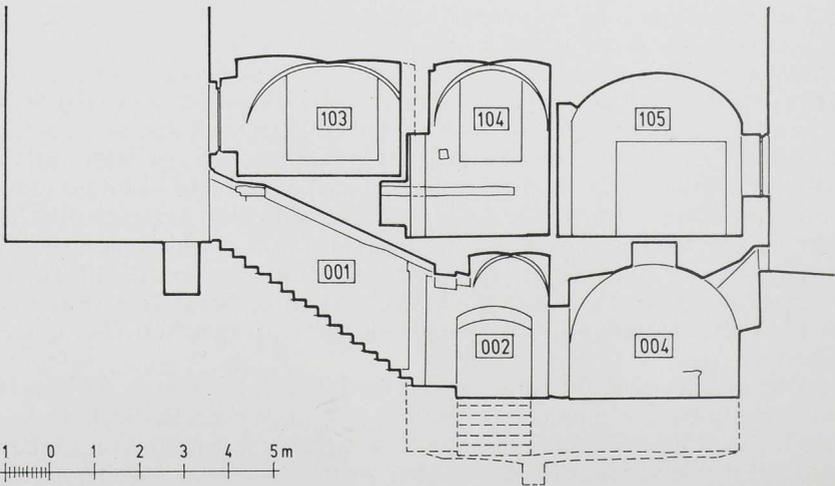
Ravensburg, Stadelgasse 1, Querschnitt durch das Unter- und Erdgeschoß.
